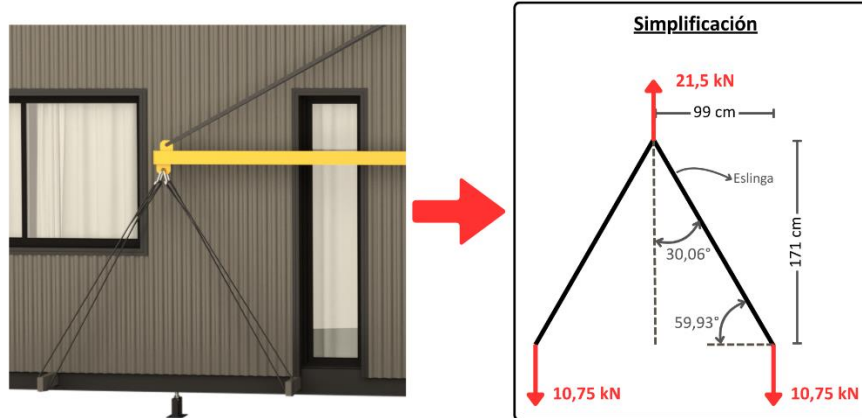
Sistema de Fuerzas actuantes en las eslingas inferiores. Fuente: Elaboración propia.
